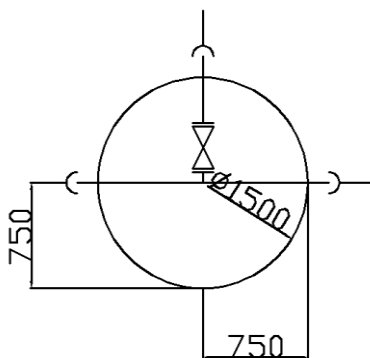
Схема присоединения ввода к наружной водопроводной сети в колодце
